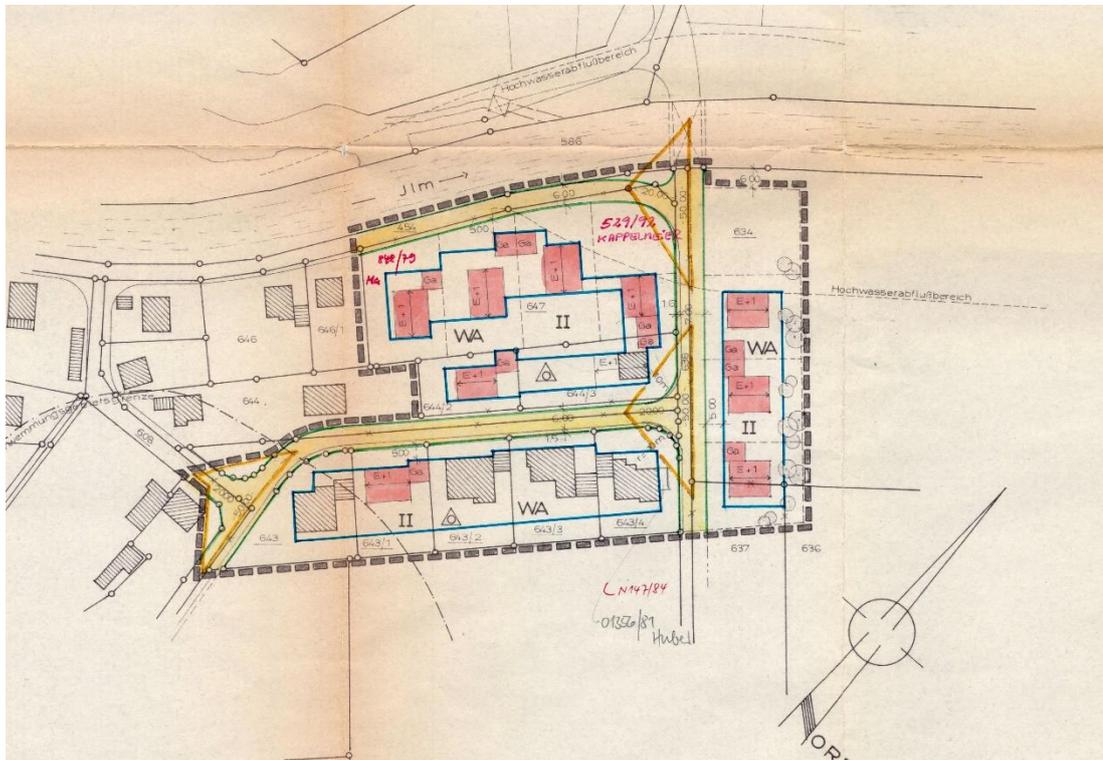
Ursprungsbebauungsplan Nr. 4 „Im Brühl“
